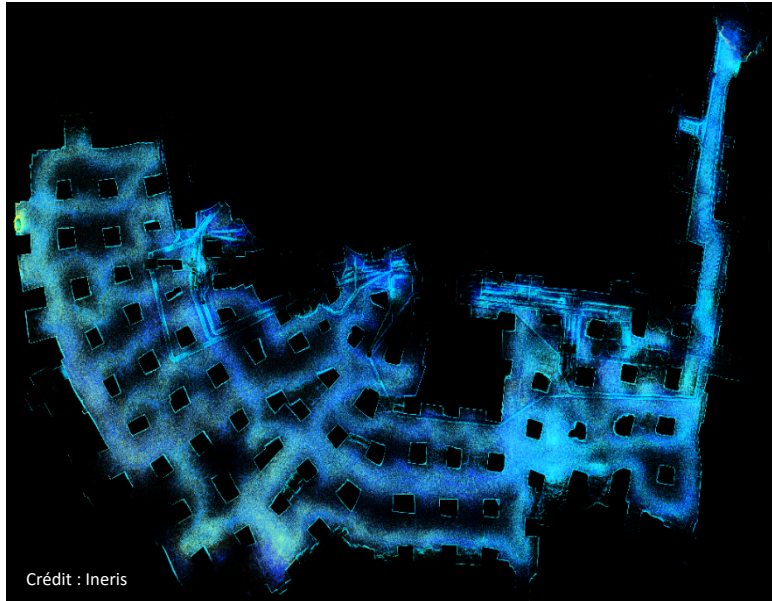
Exemple d'un plan obtenu par coupe horizontale d'un nuage de points 3D
